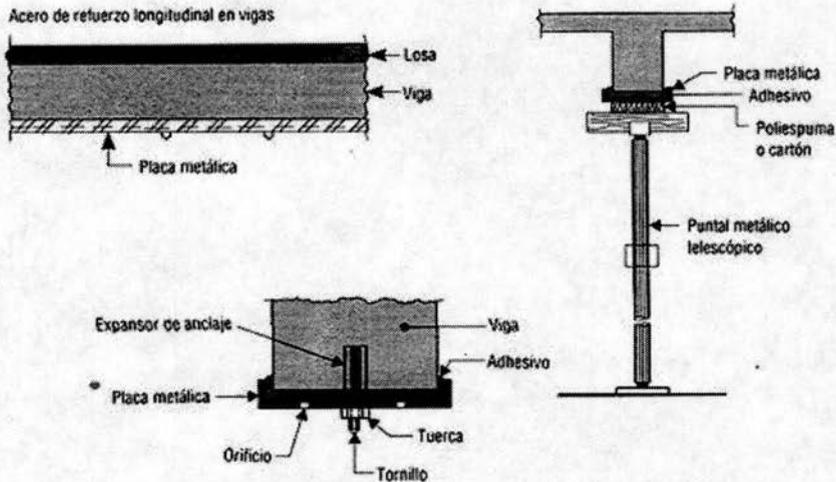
Vigas. Refuerzo – Flexión. Placas metálicas adheridas con resina epóxica
